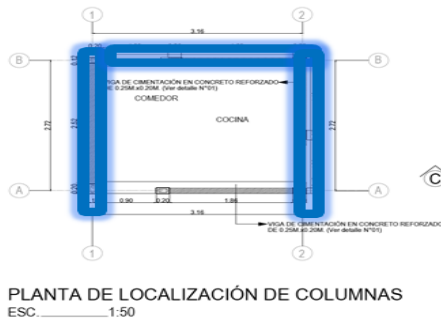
armado y figurado de vigas de amarre, Víctor molina (cocina).
